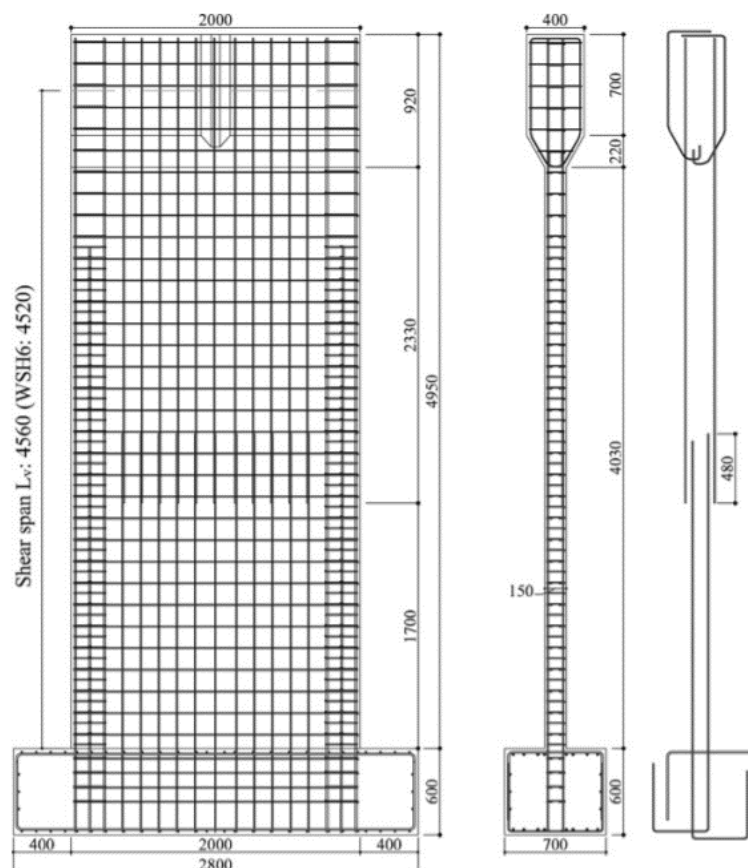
Detalles de Muro de Ensayo Cíclico del Laboratorio
